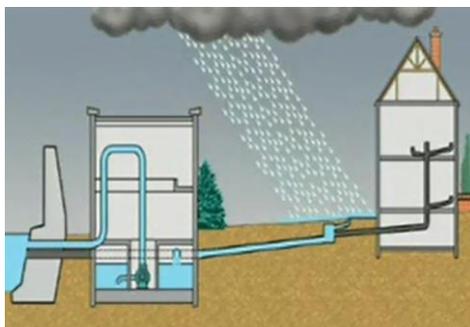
schéma d'une station de démergement (Source : AIDE)
